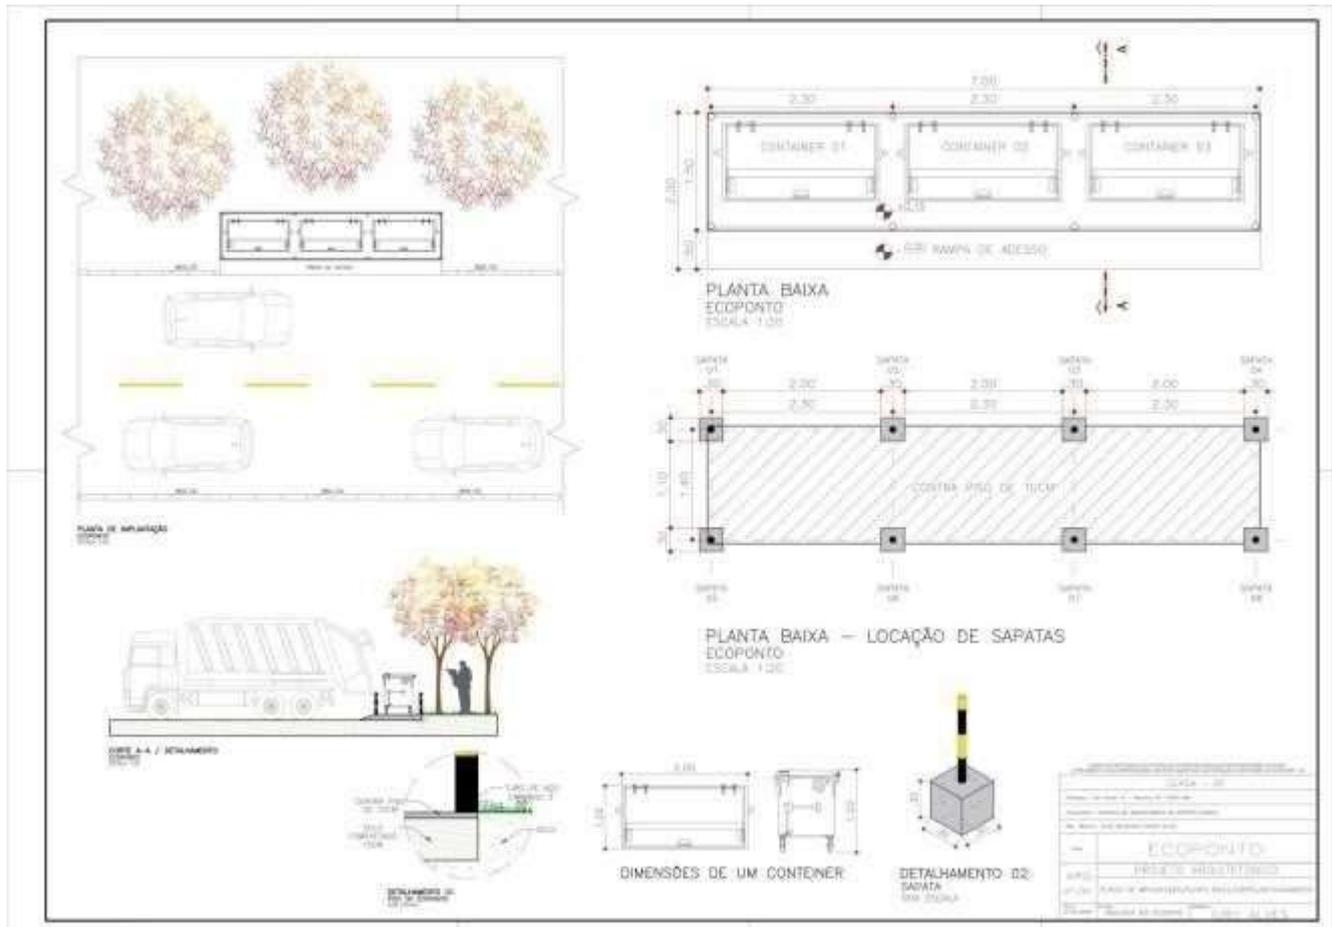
Planta baixa de Eco ponto na CEASA-DF que comporta 03 contêineres.
